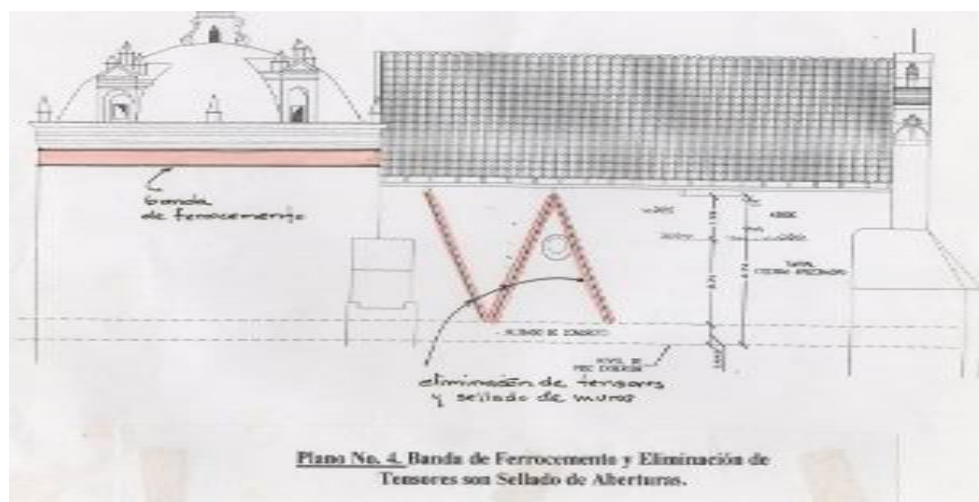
Plano de elevación de fachada lateral sur del templo (Quiñónez, 2002). (observar posición de banda de ferrocemento y ubicación de tendones eliminados)
